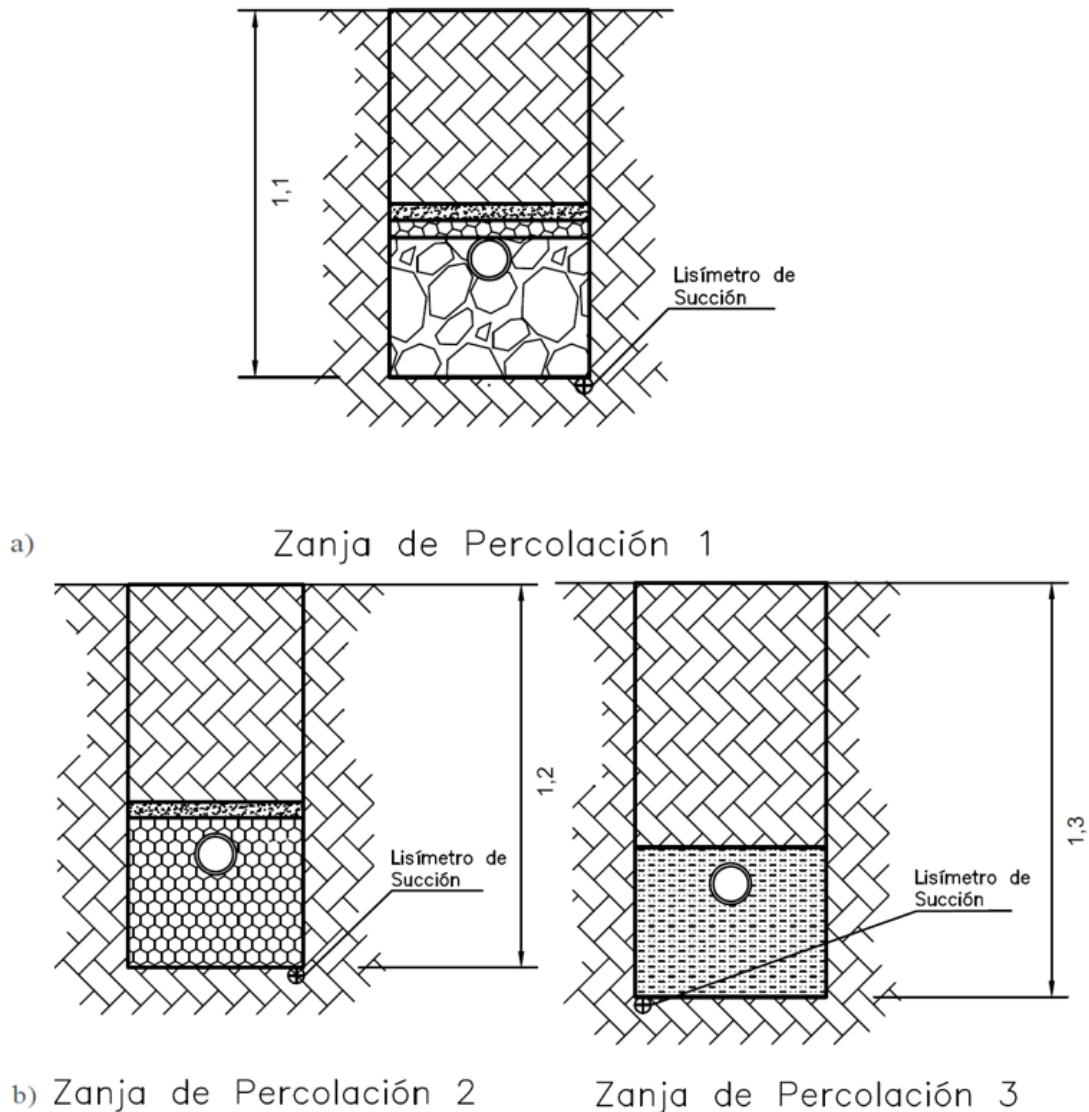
a) corte transversal, ubicación de los lisímetros de succión de la zanja de infiltración 1; b) corte transversal, ubicación de los lisímetros de succión de la zanja de infiltración 2 y 3.
